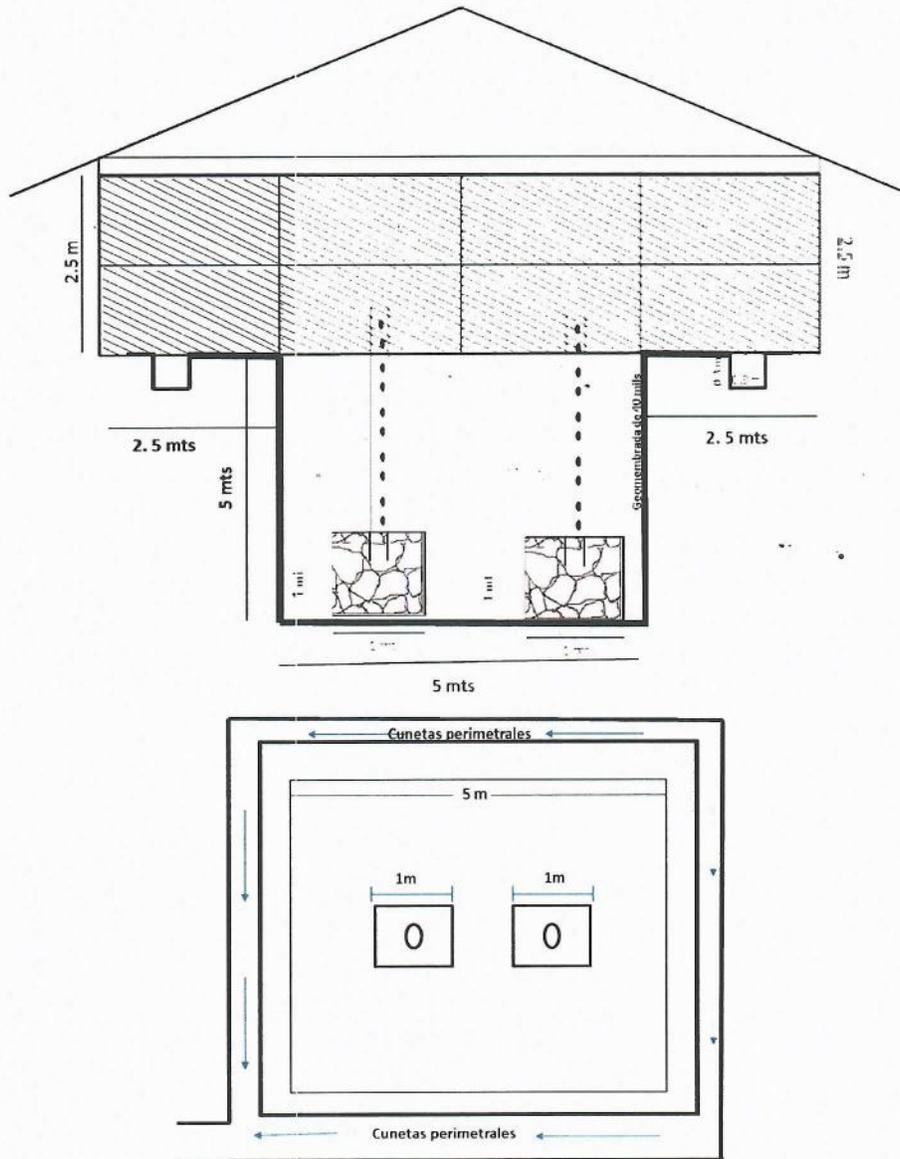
Esquema constructivo fosa para manejo de mortalidad vista lateral y planta
